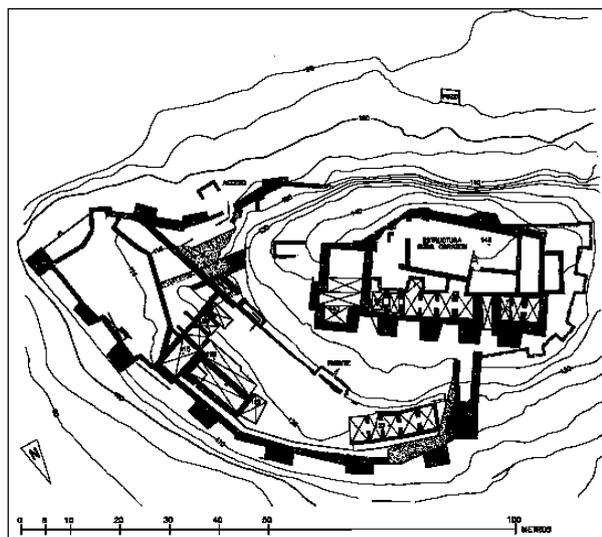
Castillo de Monteagudo. Planimetría de estructuras.
